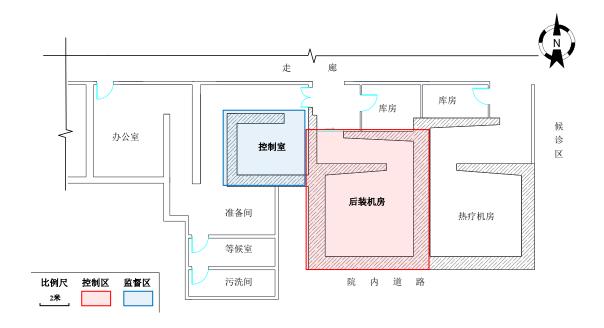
后装治疗机房平面布置及辐射防护分区示意图
